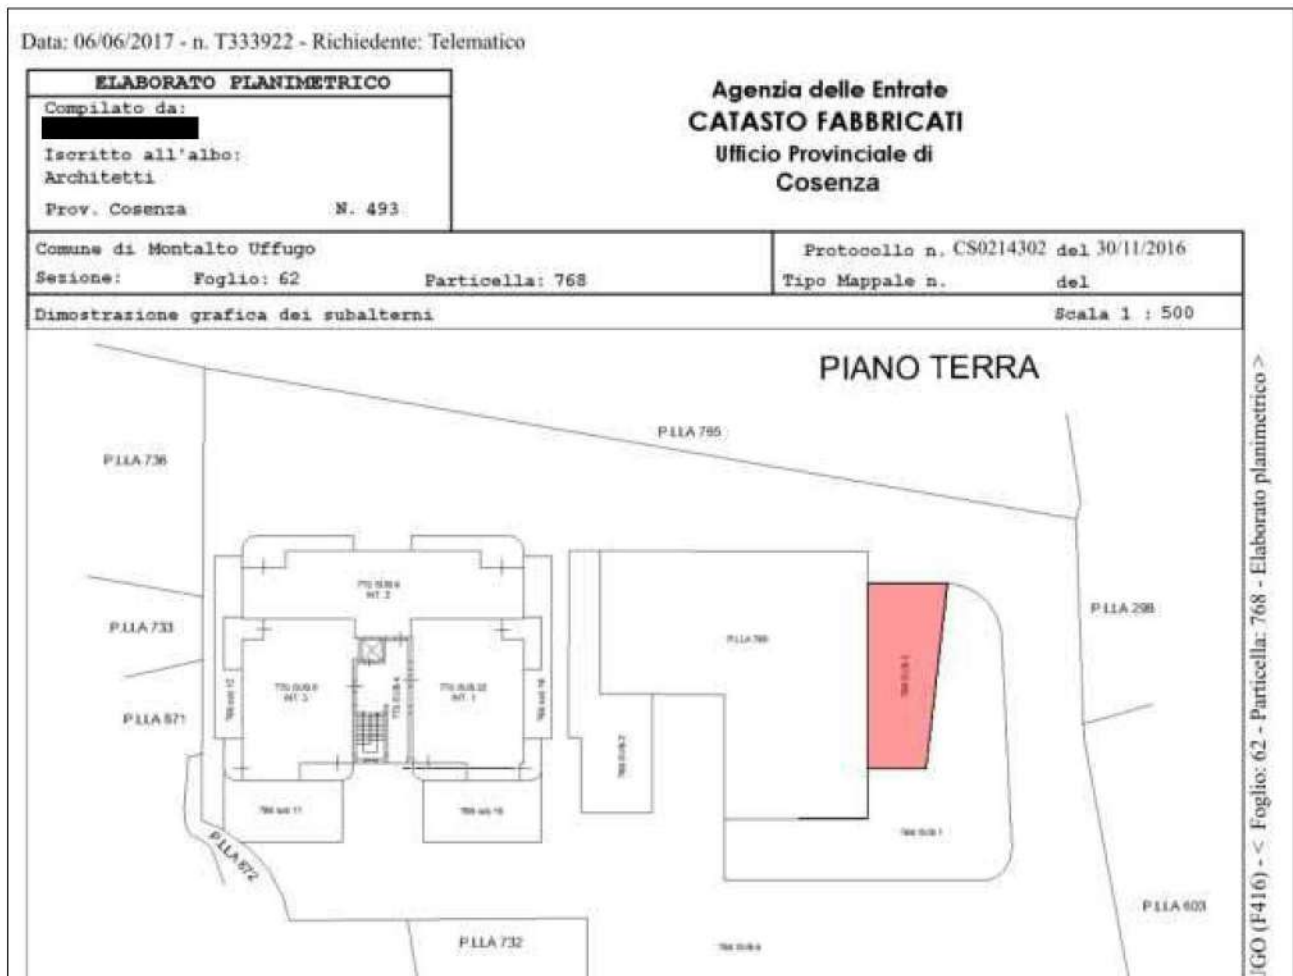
Planimetria Censuaria (Foglio 62 – Particella 768 – Sub 3)
